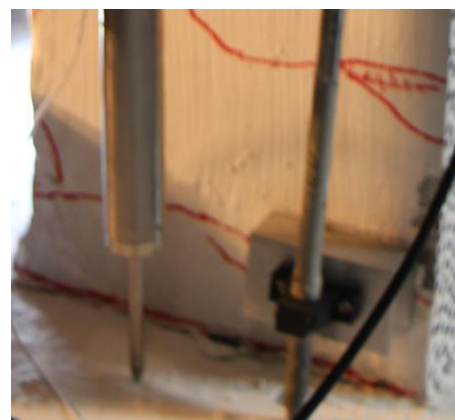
Fissures verticales de compression sur la face latérale gauche de la colonne C3A au LS32
